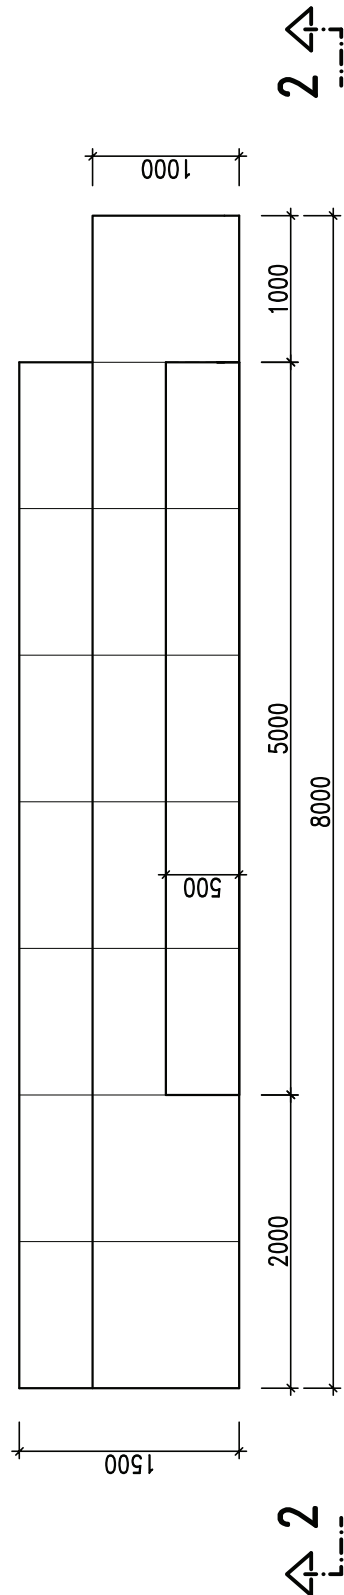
A. GABIONOVÁ ZEĎ U OPĚRY 04 ČELNÍ POHLED A PŮDORYS
